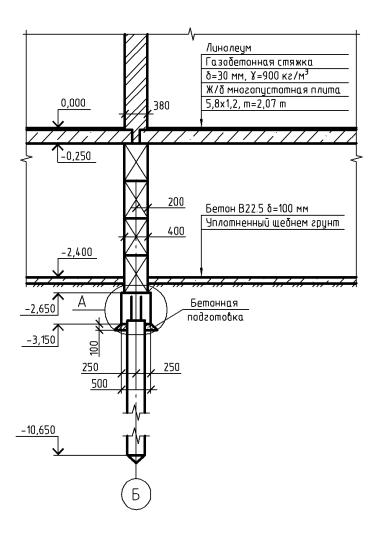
Пример оформления разреза ленточного свайного фундамента
